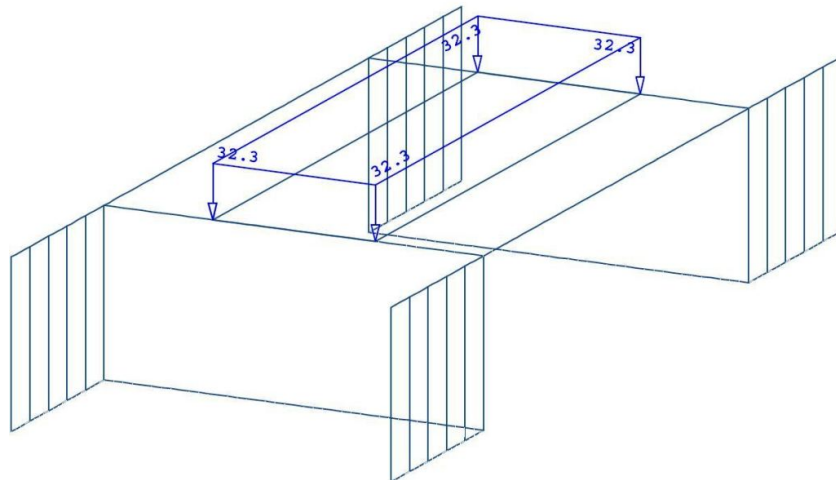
LF 102 Grundlast - SOFISTIK
